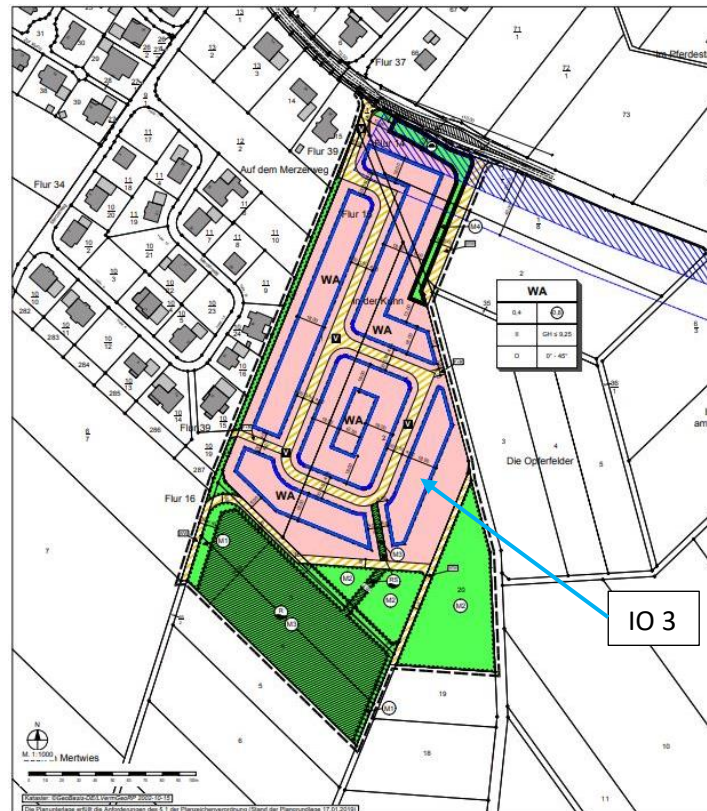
Auszug aus dem Bebauungsplan „Mertwies“ der Gemeinde Badem [17]
